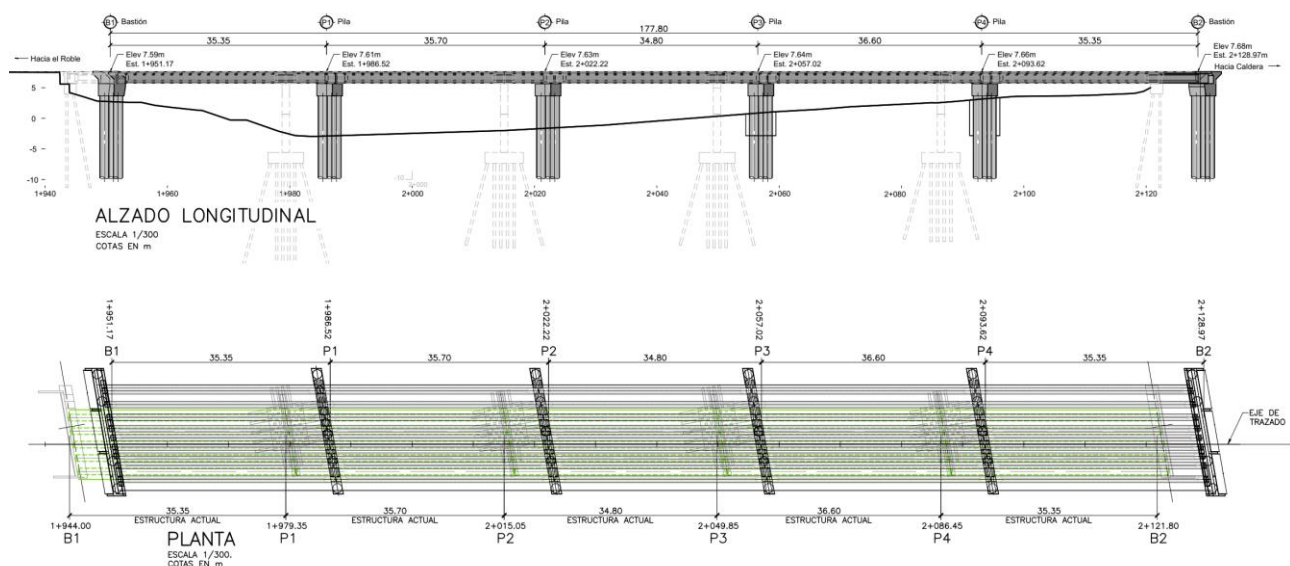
Alzado y planta del nuevo puente sobre río Barranca
